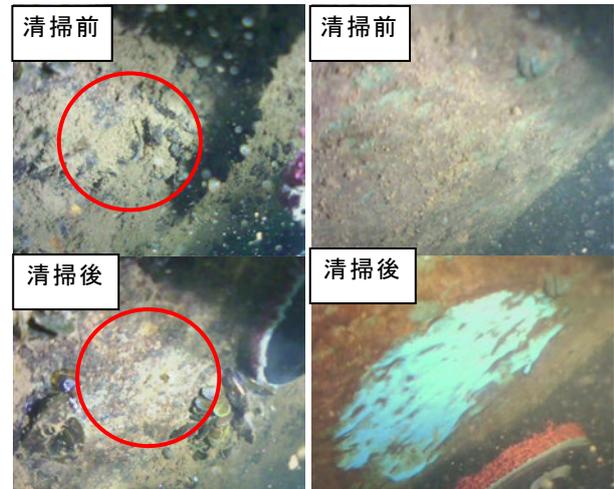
堤体面清掃状況 写真-15 鋼材面清掃状況
